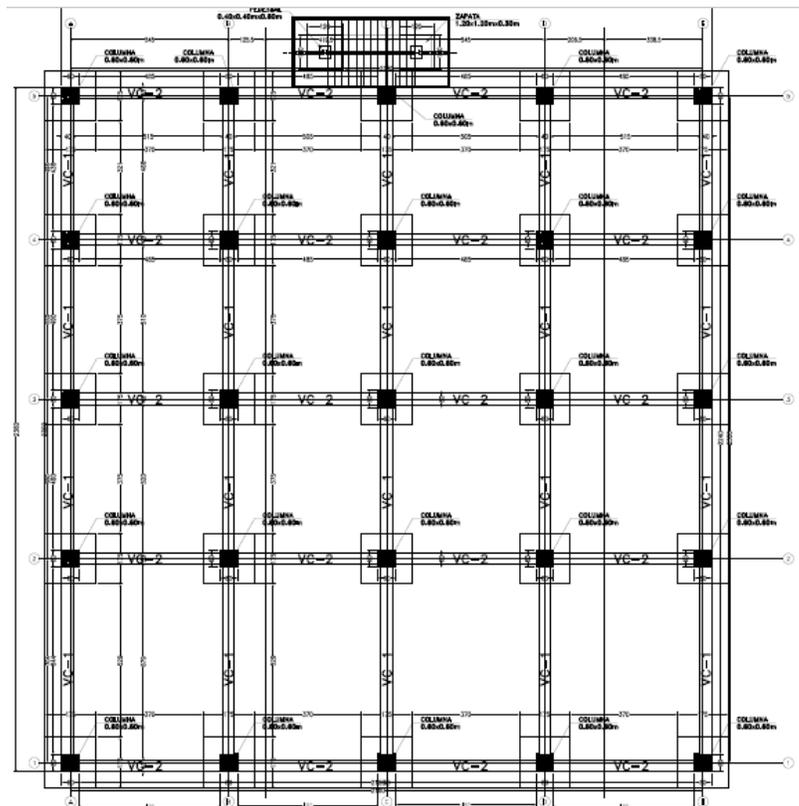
Planta cimentación edificio de deshidratación. Fuente: AutoCAD (amb S.A. E.S.P, 2019)
